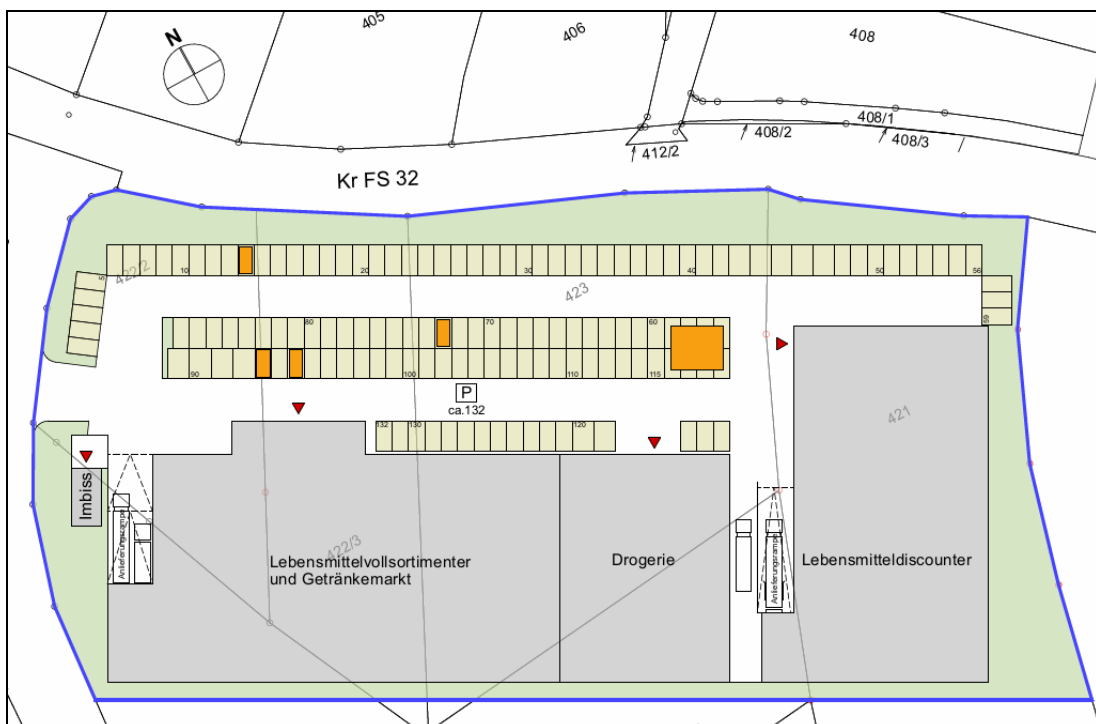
Lageplan des Sondergebiets (nicht genordet) mit geplanter Nutzung [b]
